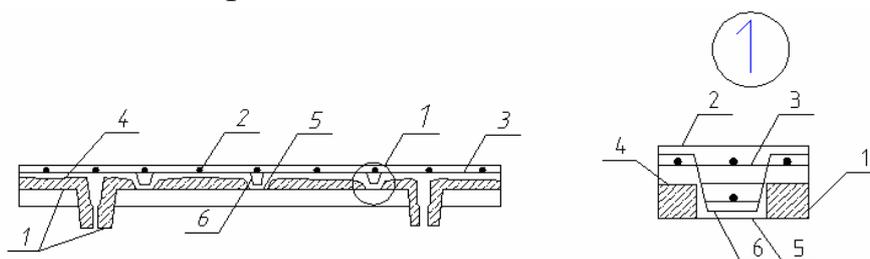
Усиление ребристых плит наращиванием сечения: 1 – усиливаемые плиты; 2 – монолитный слой бетона; 3 – арматурная сетка; 4 – поверхность сцепления монолитного бетона с плитой; 5 – вырубленные участки полок плит с сохранением арматурных сеток; 6 – арматурные гнутые стержни
